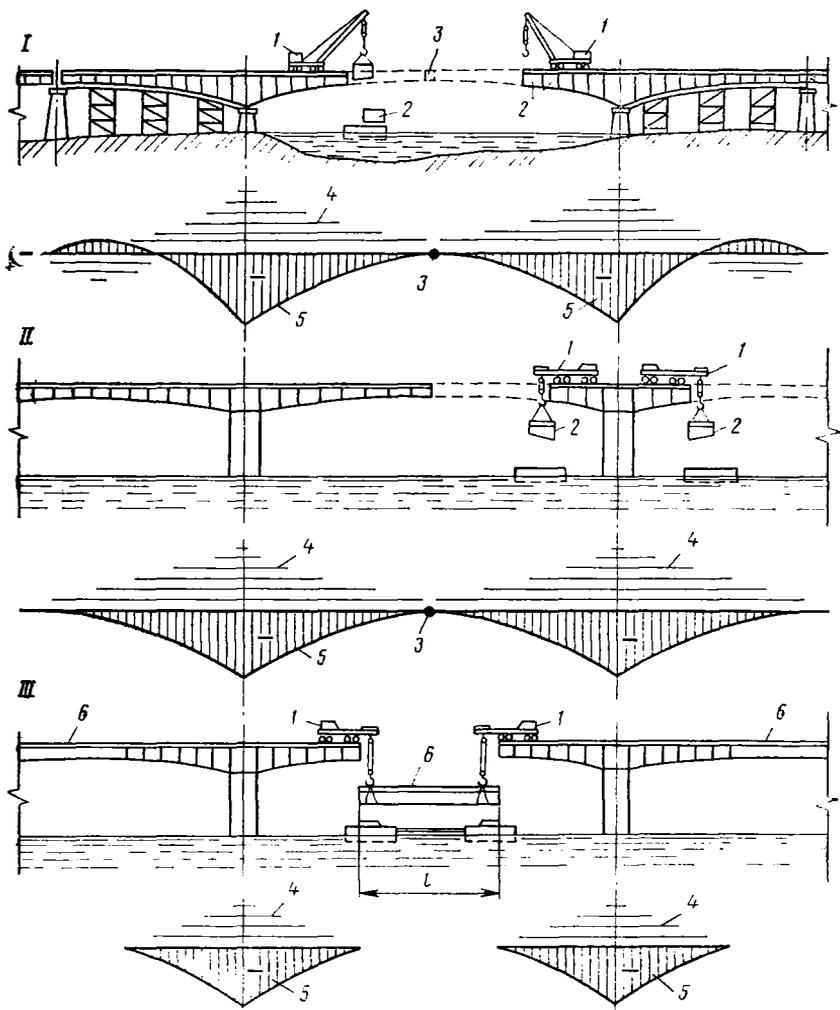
Схемы (I—III) навесной сборки консольных пролетных строений:
